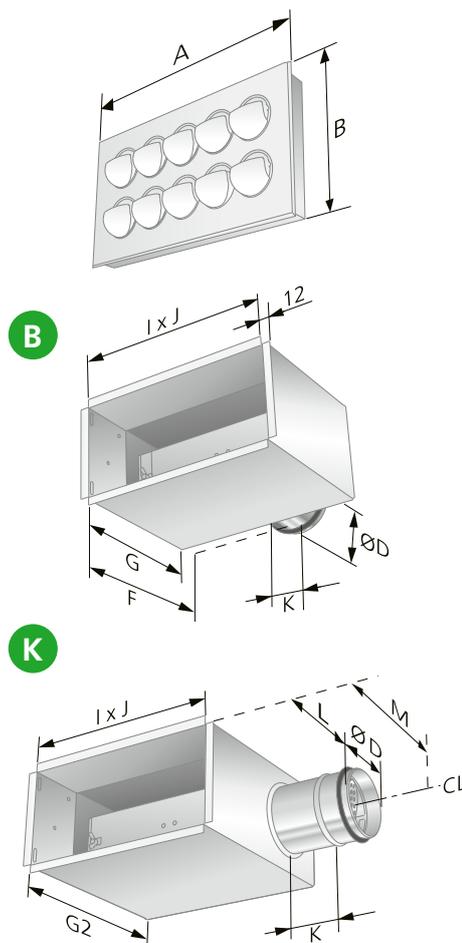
Abmessungen, EAGLE Wall und Anschlusskasten ALV.
